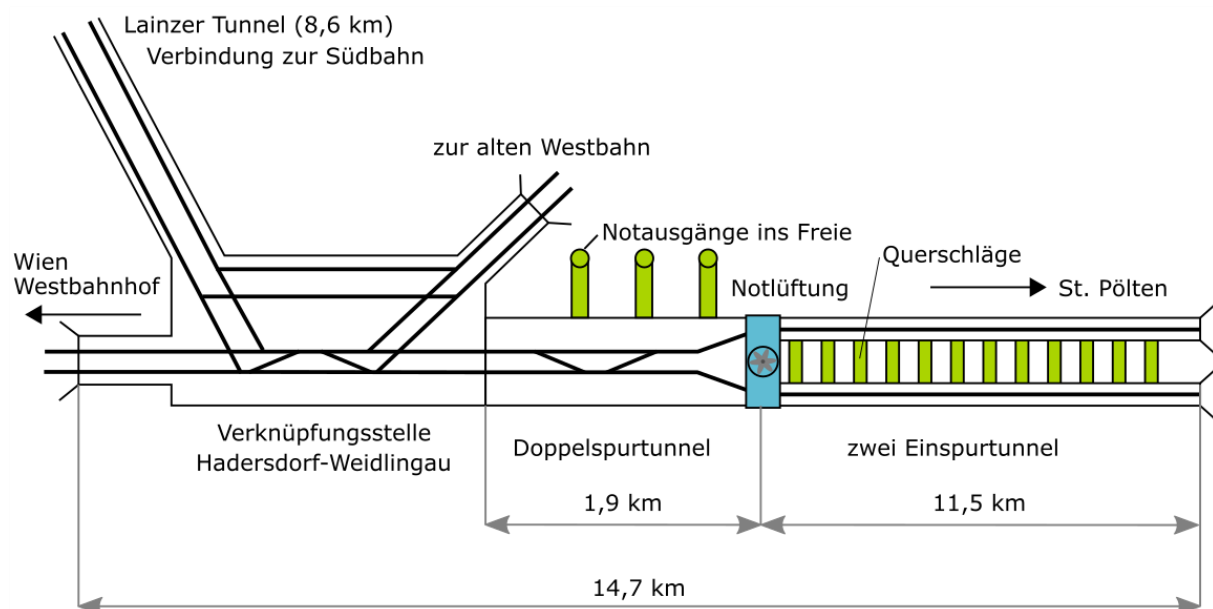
Schema Wienerwaldtunnel (zitiert nach: [36])
